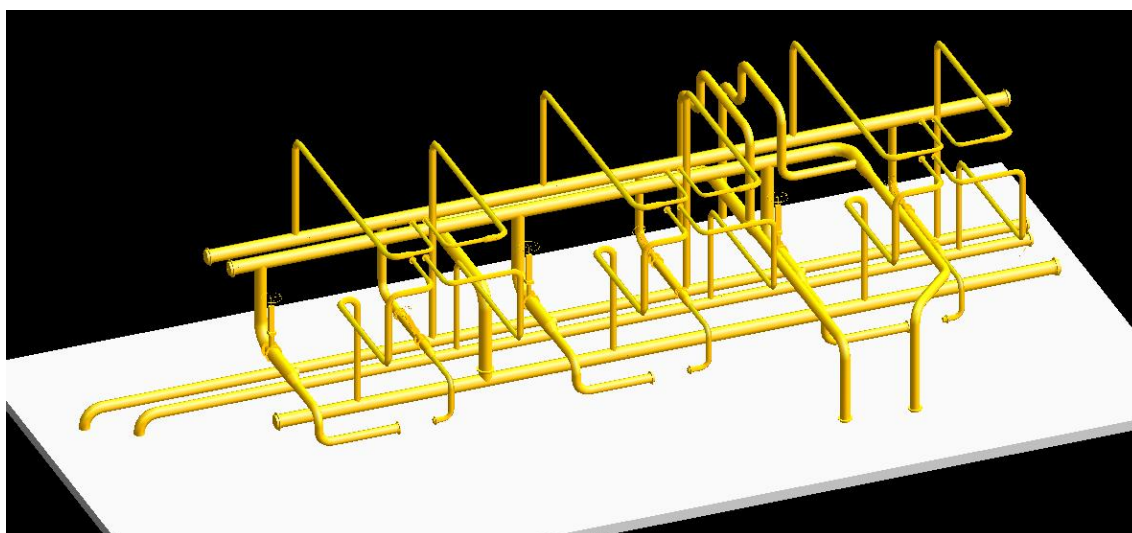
Entramado de tuberías en 3D de la planta creada en PDMS.
